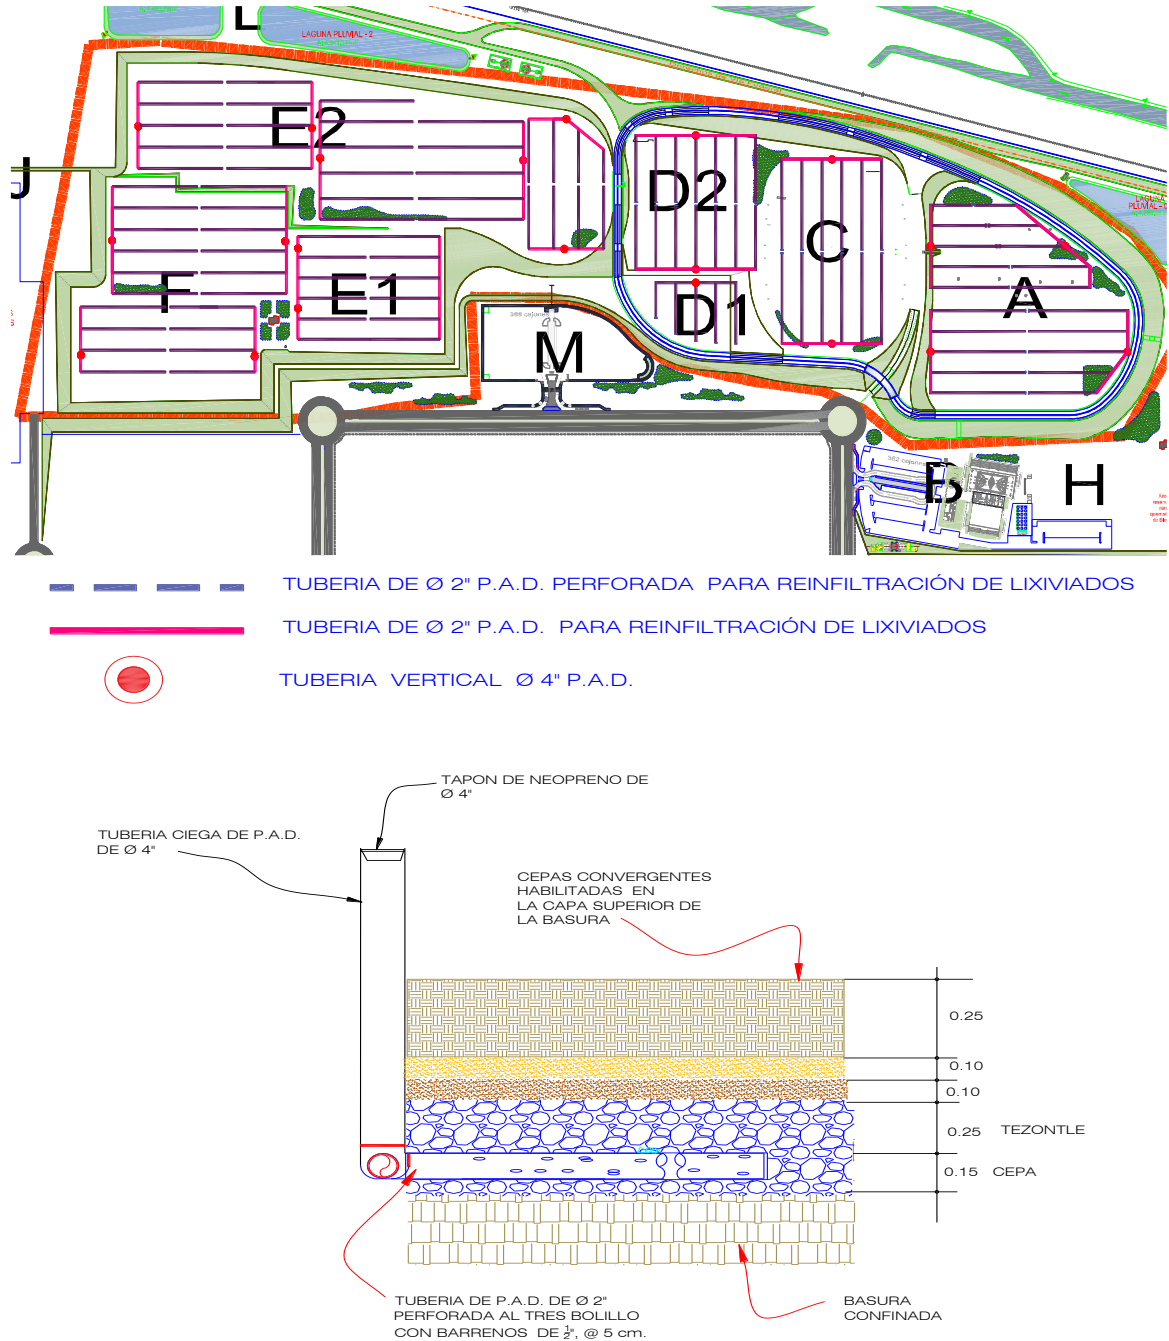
Sistema de re-infiltración de lixiviados. Planta del proyecto y detalle de la re-infiltración
